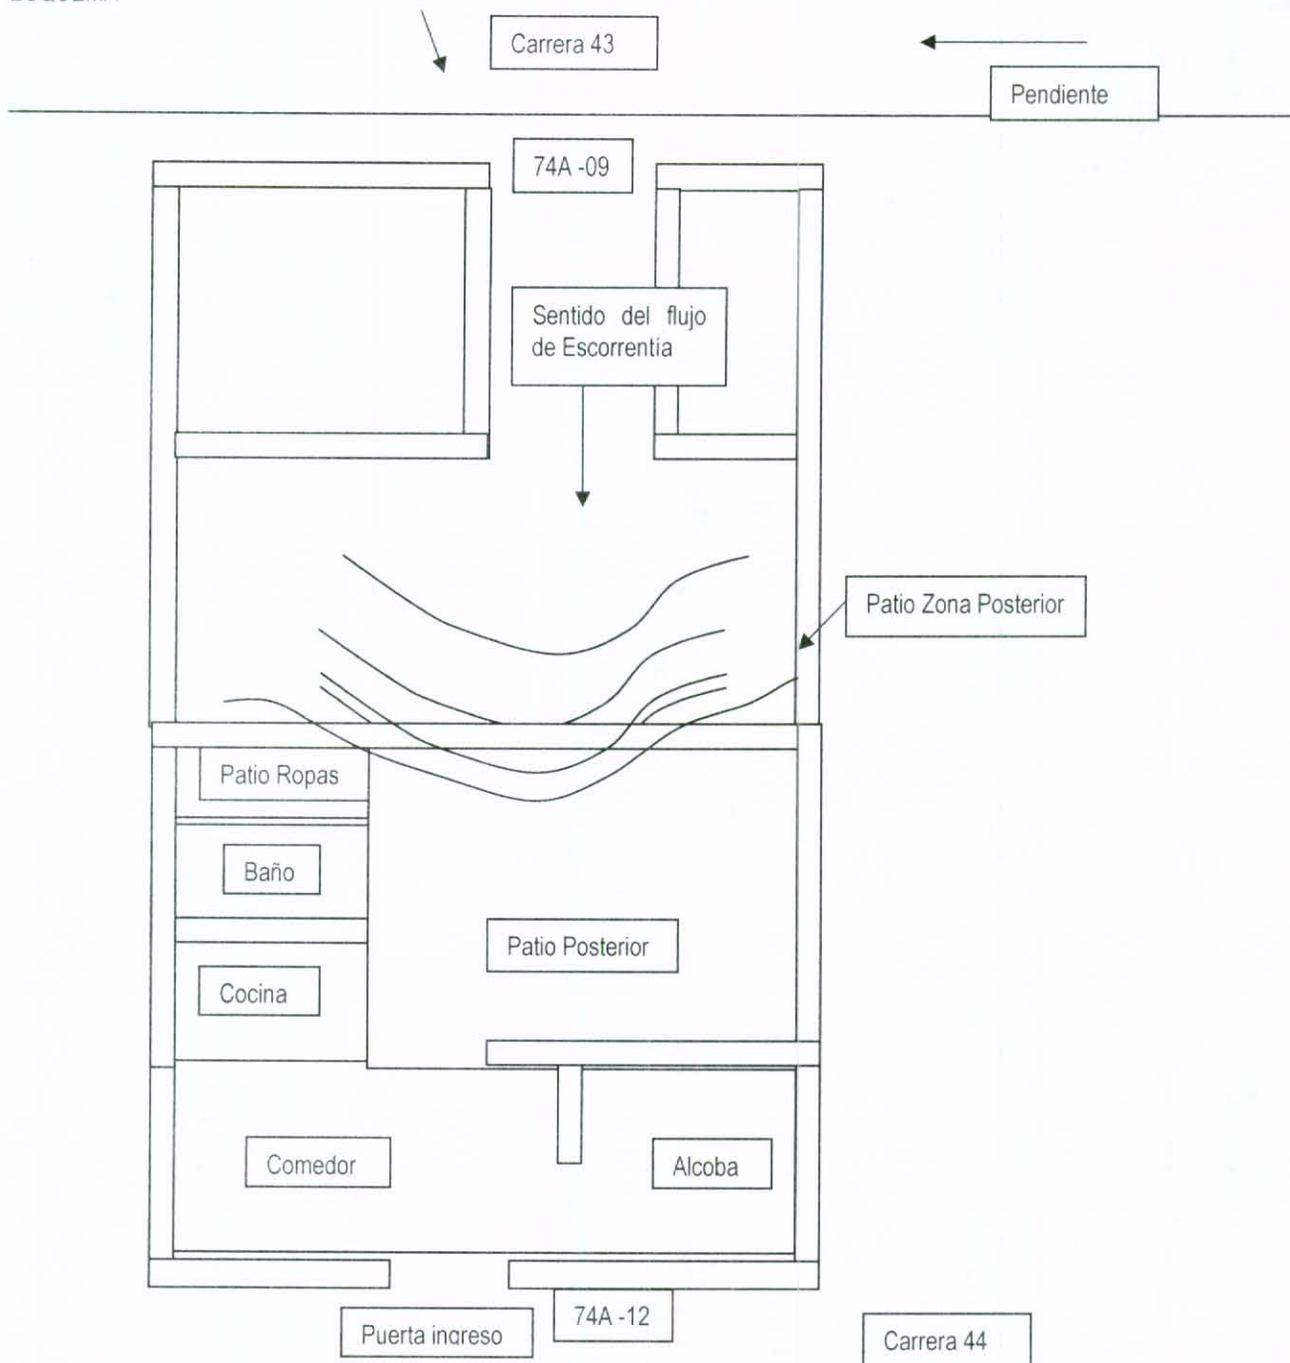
Esquema en planta de la localización de las viviendas involucradas en el evento.
